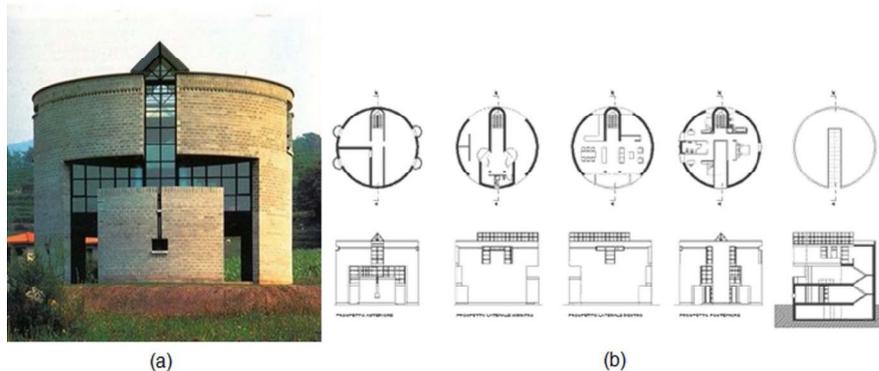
Mario Botta, Casa Rotonda, Suiza, (1980-1982): (a) Vista exterior, (b) Plantas arquitectónicas, Alzados y Sección.
